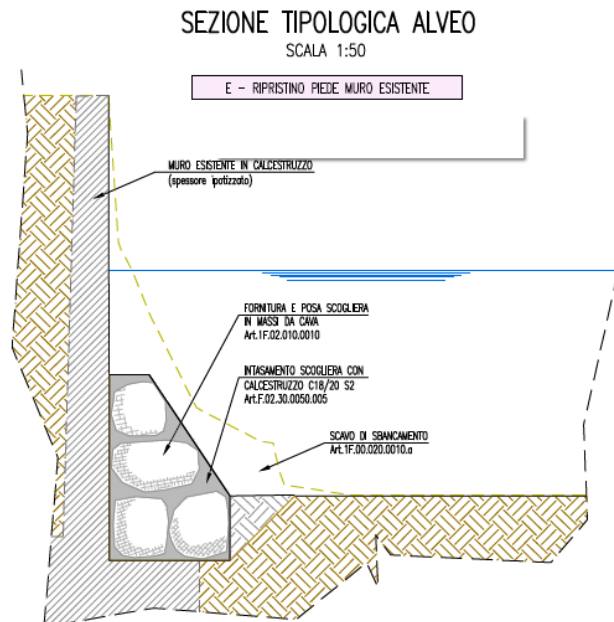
Estratto Tavola 17. Sezioni tipologiche e particolari. Dettaglio dell'intervento E – Ripristino piede muro esistente.
